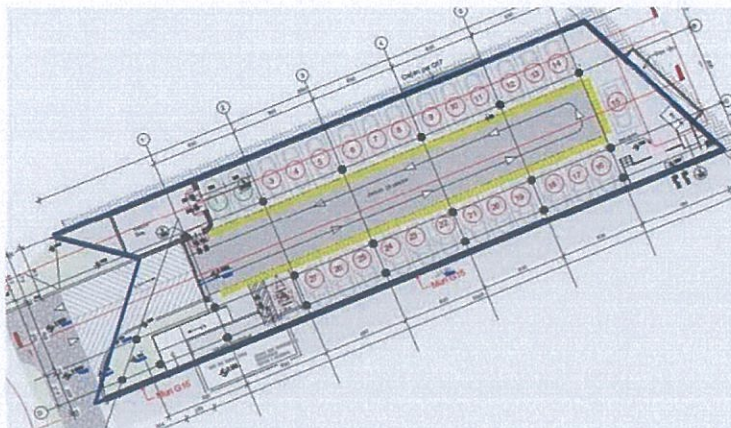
Planimetria kuote -0.60- Parkim I vecuar- Sip. 963 m<sup>2</sup>
